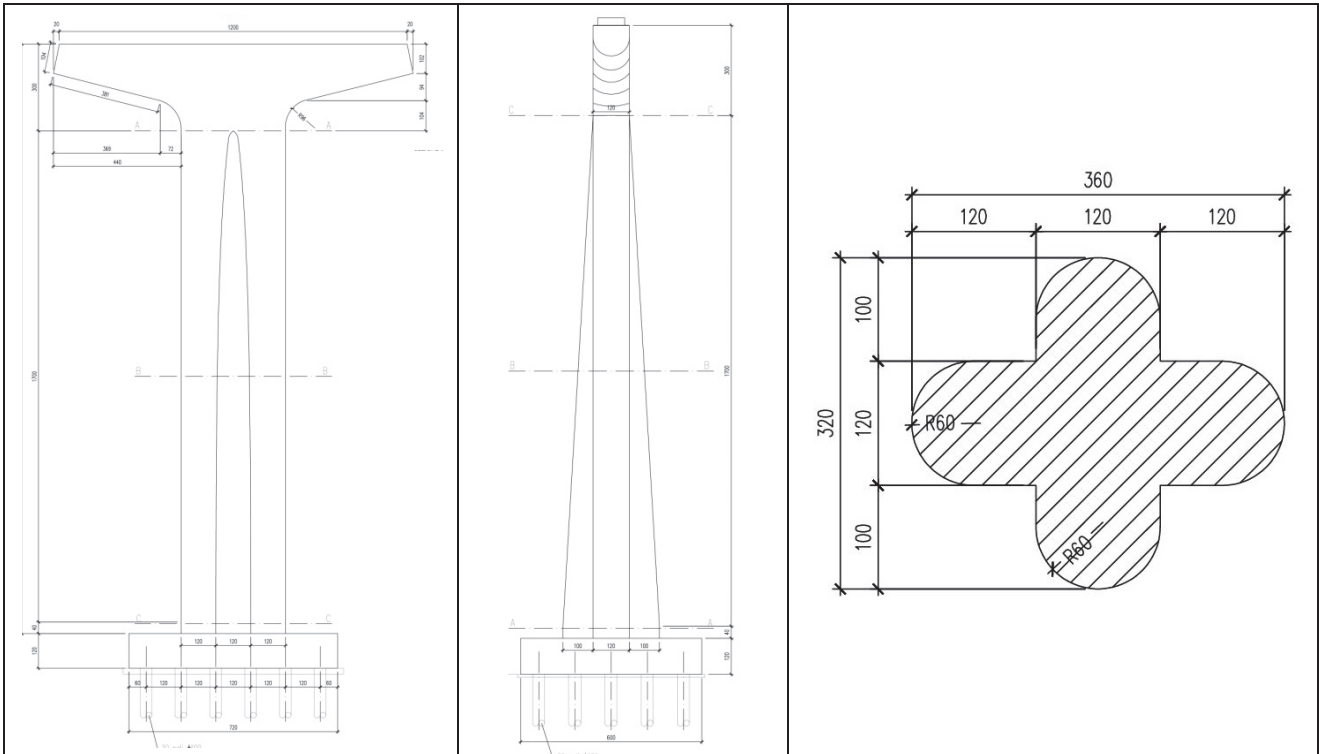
Pila 1: Prospetto longitudinale e sezione trasversale
